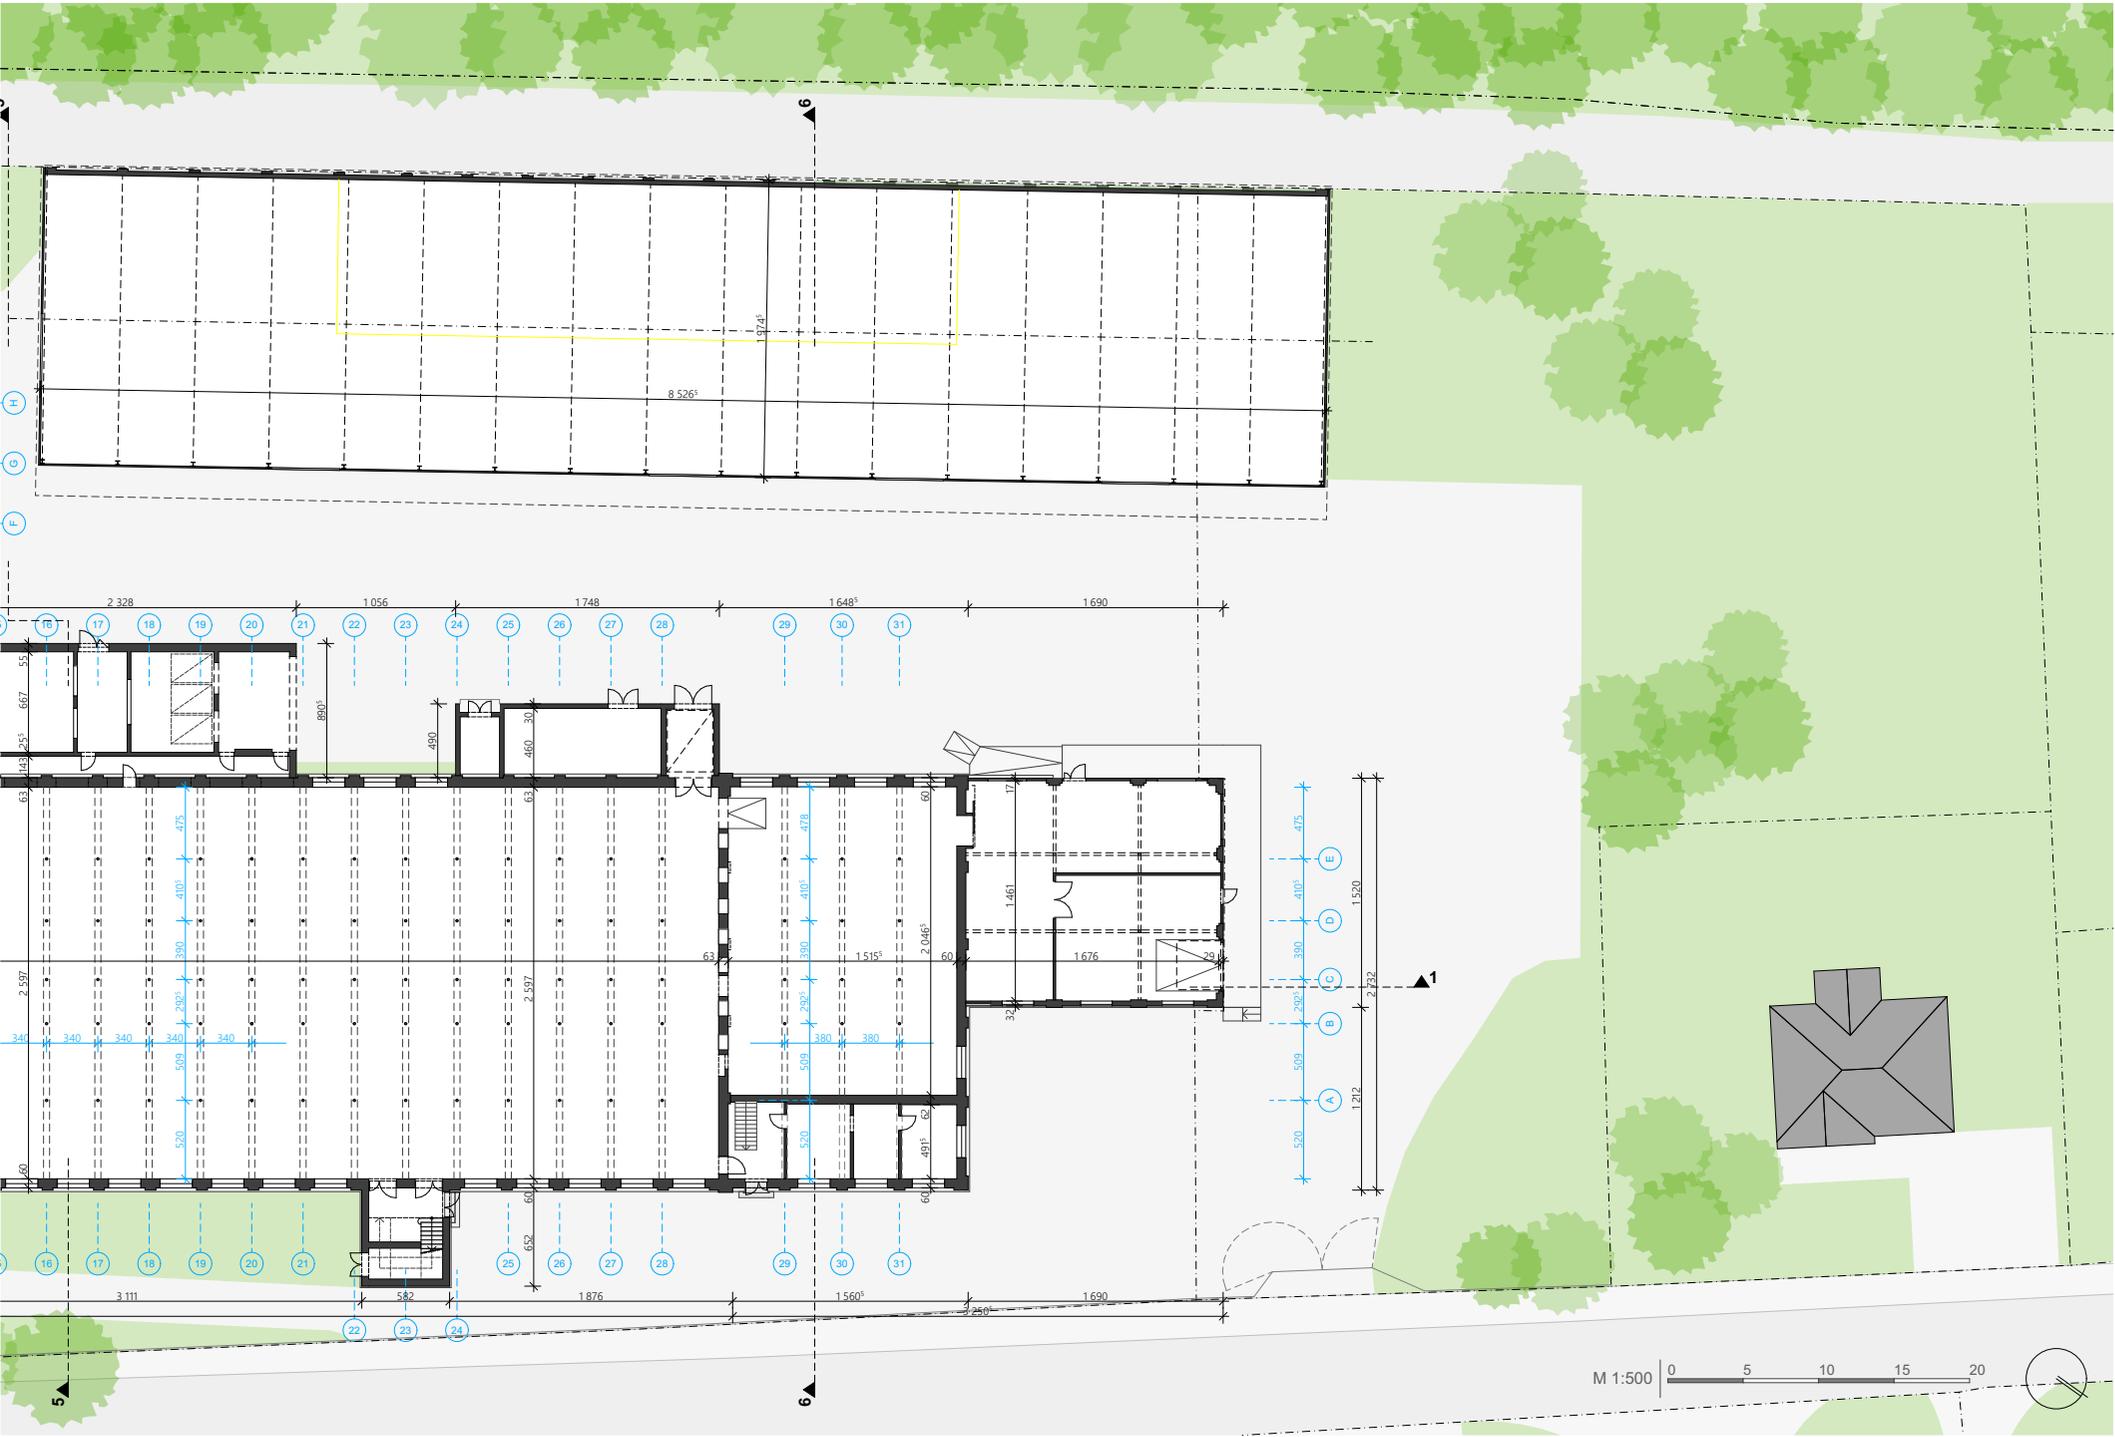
Grundriss Erdgeschoß, M 1:500
